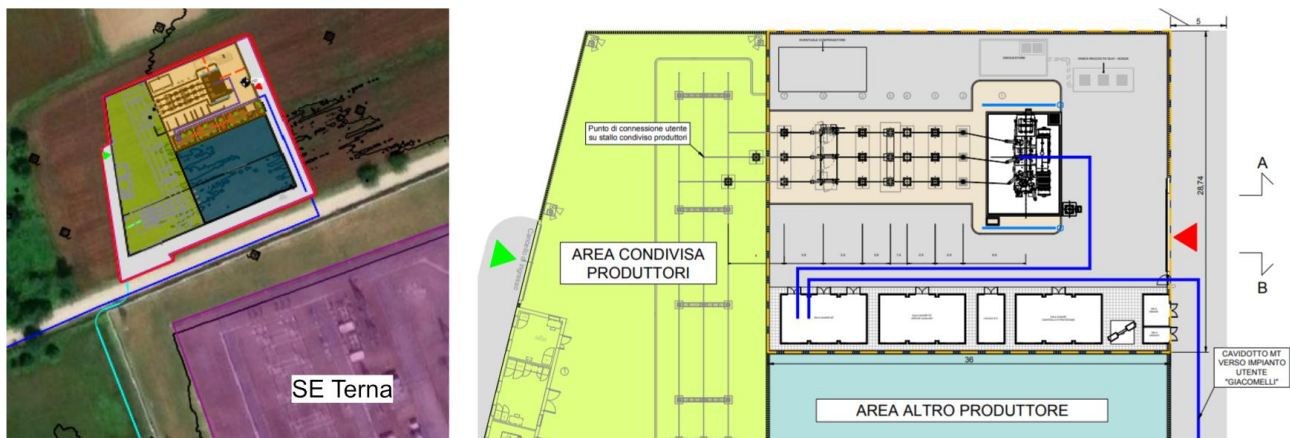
Planimetria della Stazione utente di trasformazione 30/150 kV
